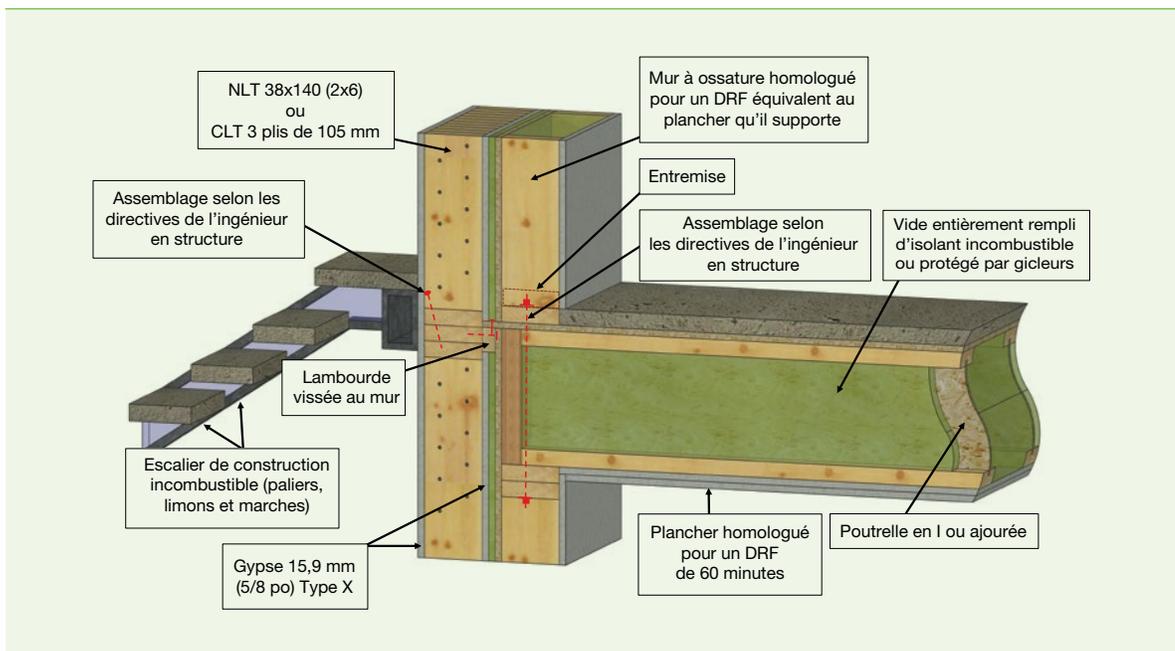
• Détail de jonction mur/poutrelle en I ou ajourée appuyée par la membrure inférieure
